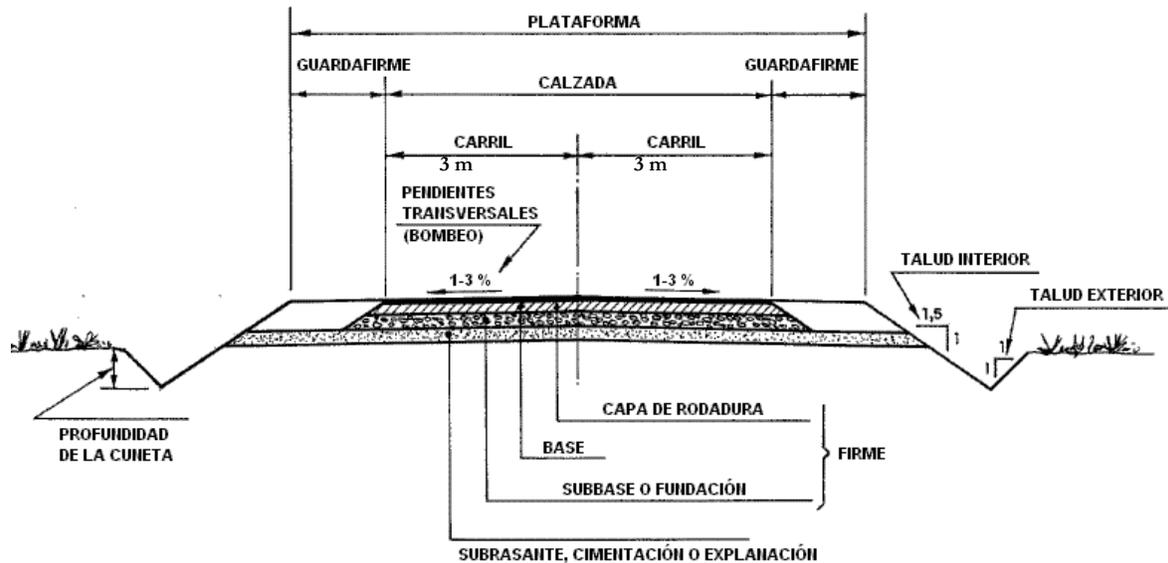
Sección transversal de la estructura del Camino de Acceso.
